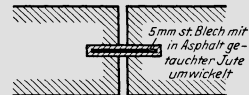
Schlitz zur Ermöglichung der Wärmeausdehnung bei Talsperren.
